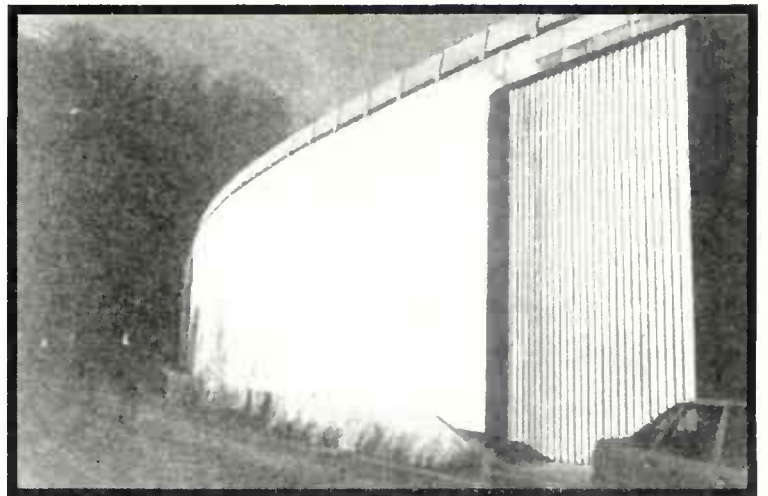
Confortement par deux voiles parallèles en béton armé (projeté) reliés par des tirants passifs horizontaux
